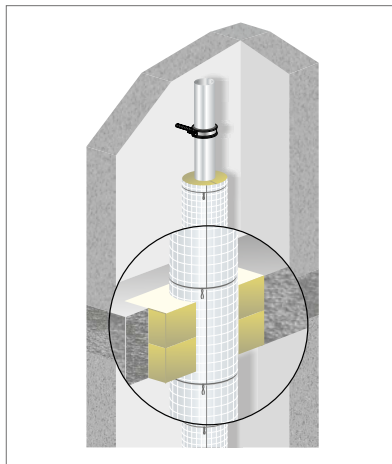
Dämmung durch Weichschott hindurchgeführt – Decke
